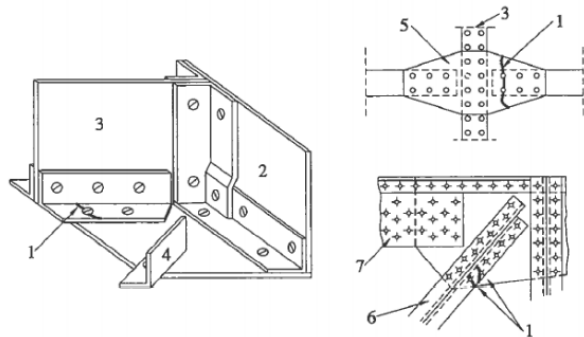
Grietas de Fatiga en Puentes en Celosía Remachados.
